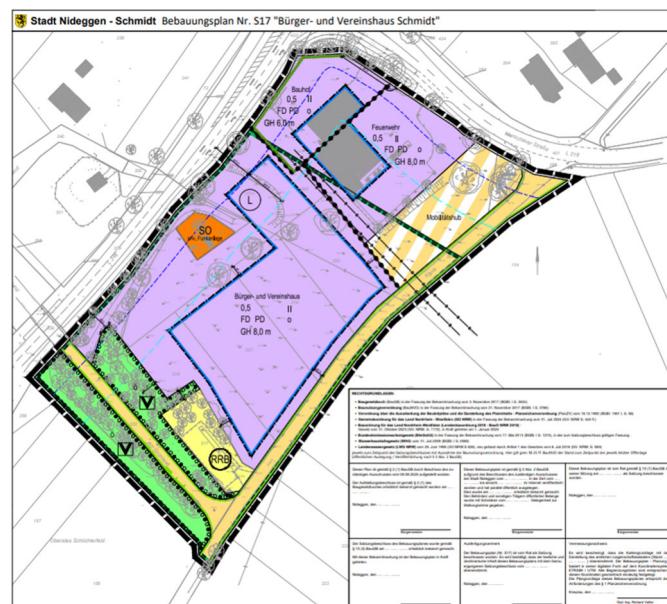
Plandarstellung des Bebauungsplans S 17
